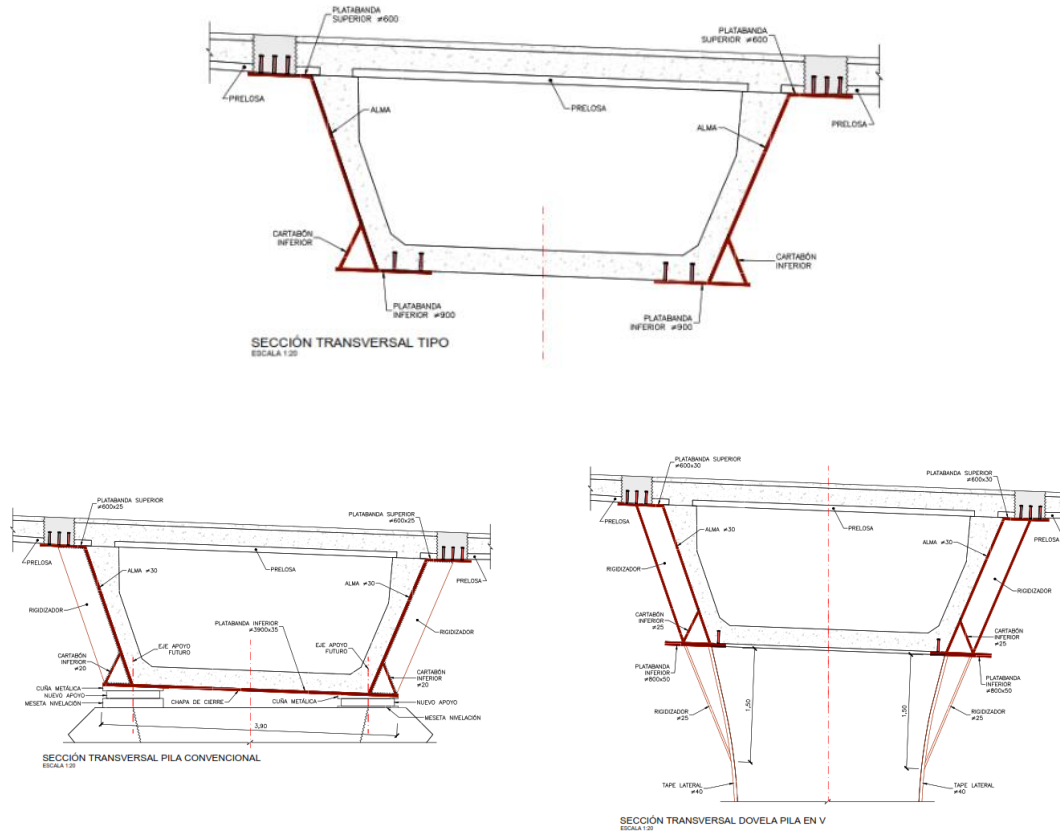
Semi sección metálica anexada con vinculación en losa superior y paramento inferior de viga artesa.
